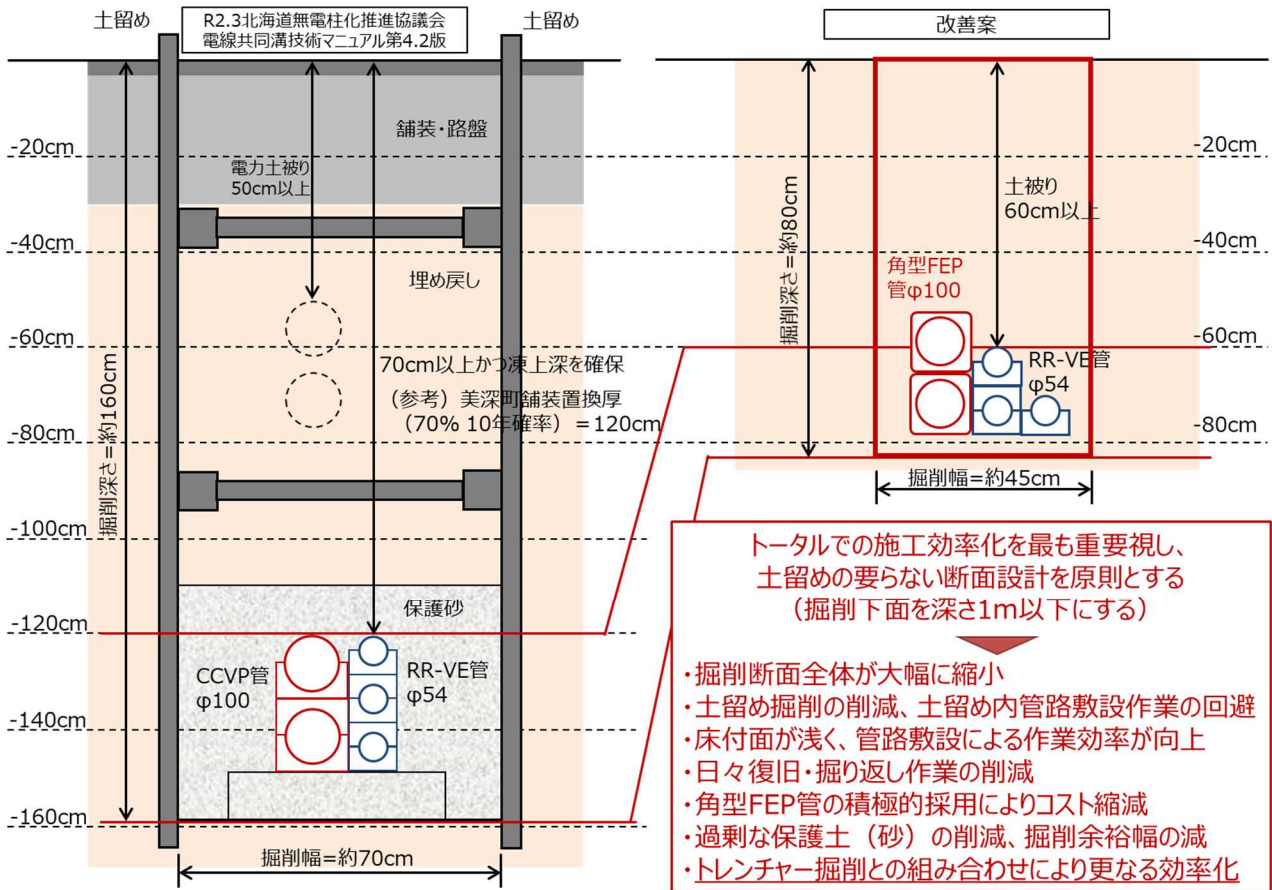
施工断面縮小による低コスト化・施工効率化（自然域の例）
